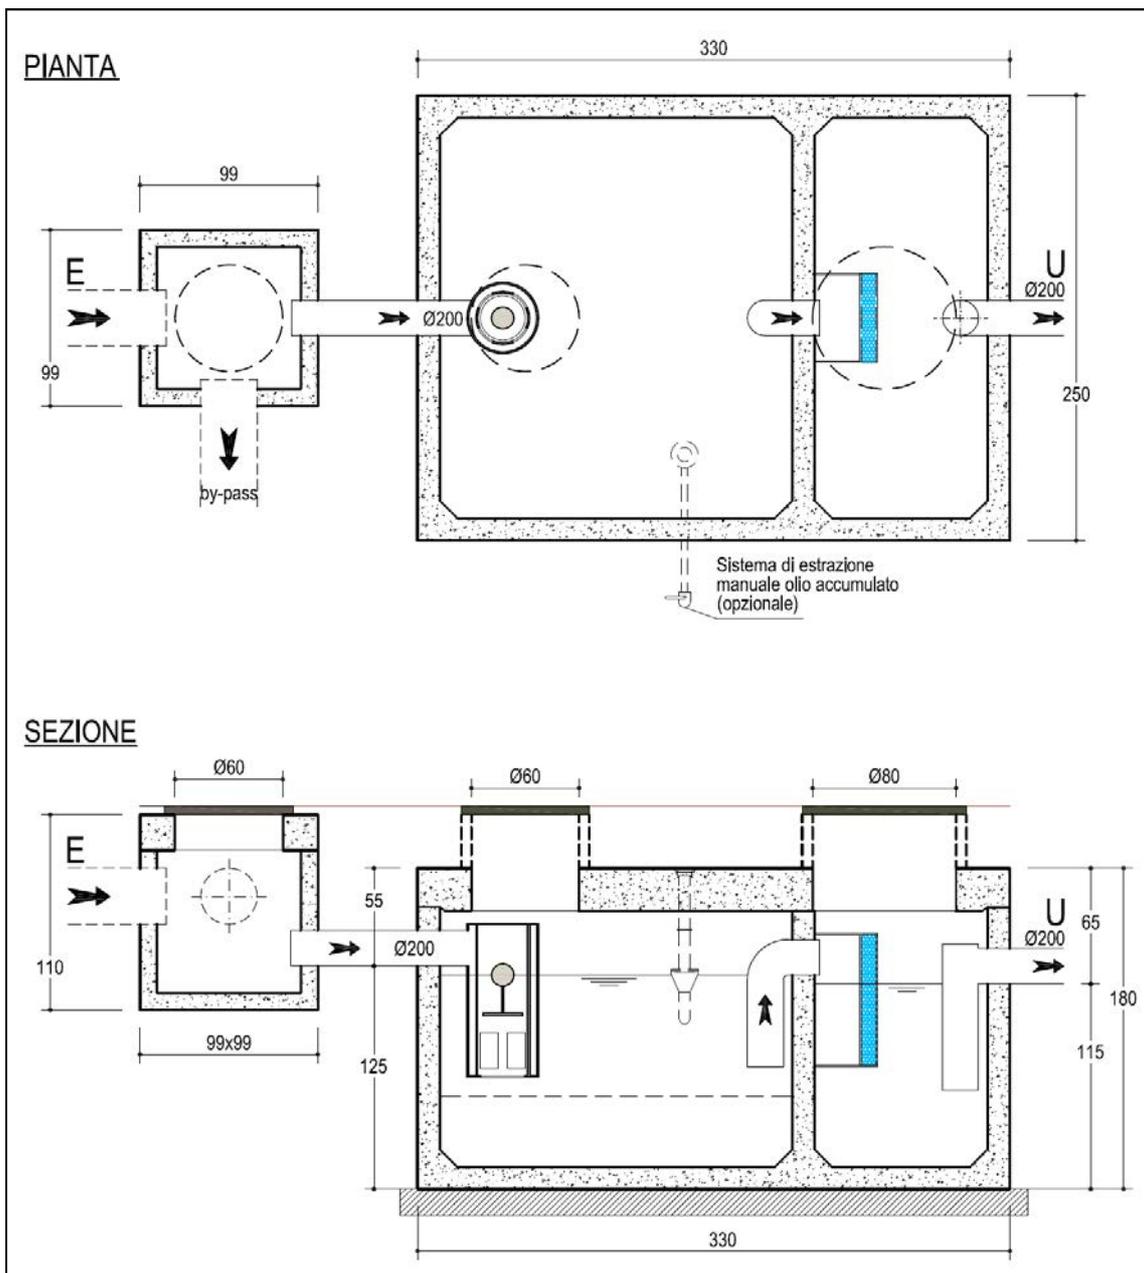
Vista planimetria e in sezione dell'impianto di depurazione delle acque prima pioggia.
